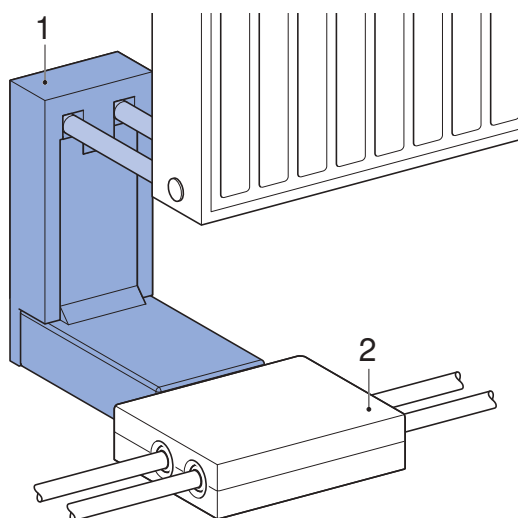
Caja de conexión de radiador tipo C para construcciones de soldado elevadas
